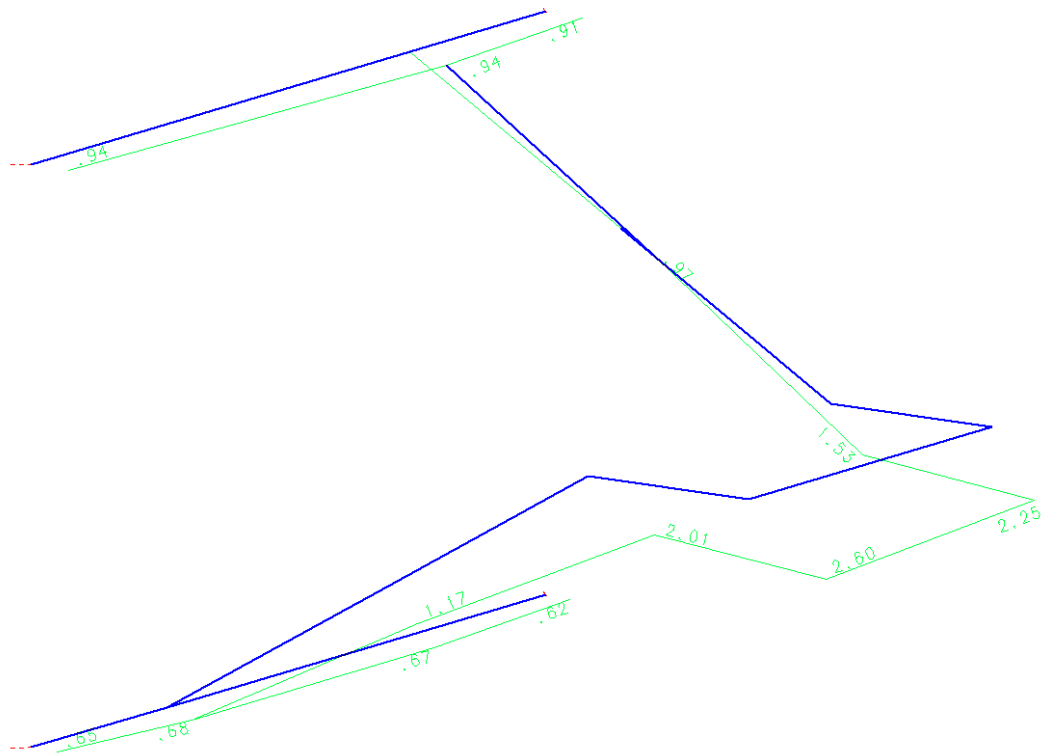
41 - Flechas do pórtico espacial formado pelas vigas de escada.
